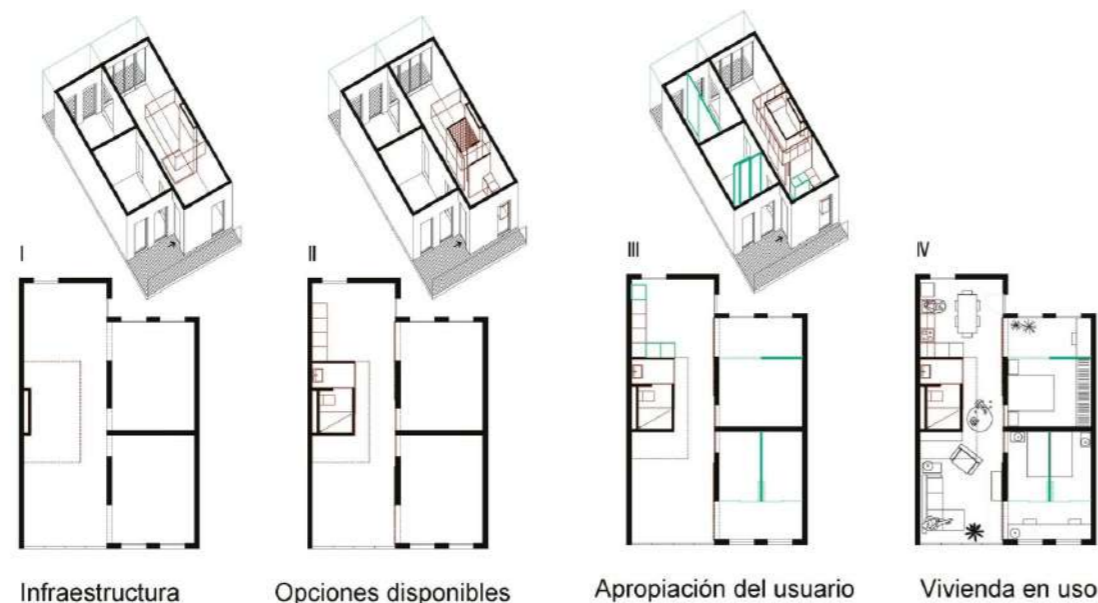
Planta y fachada de vivienda modular. Redibujo con autoría propia a partir de Construable.es.
